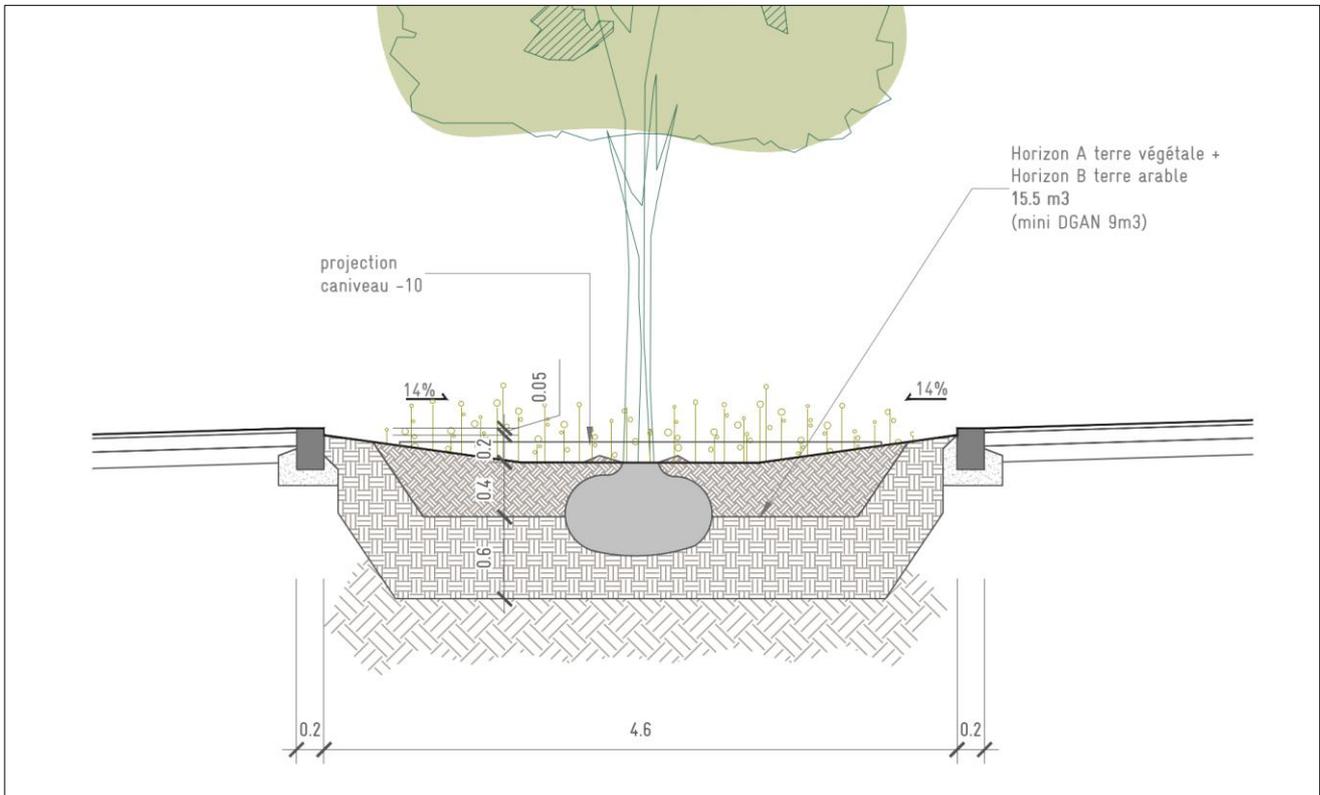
Coupe transversale sur berme centrale avec fosse de plantation, extraite du rapport paysager
